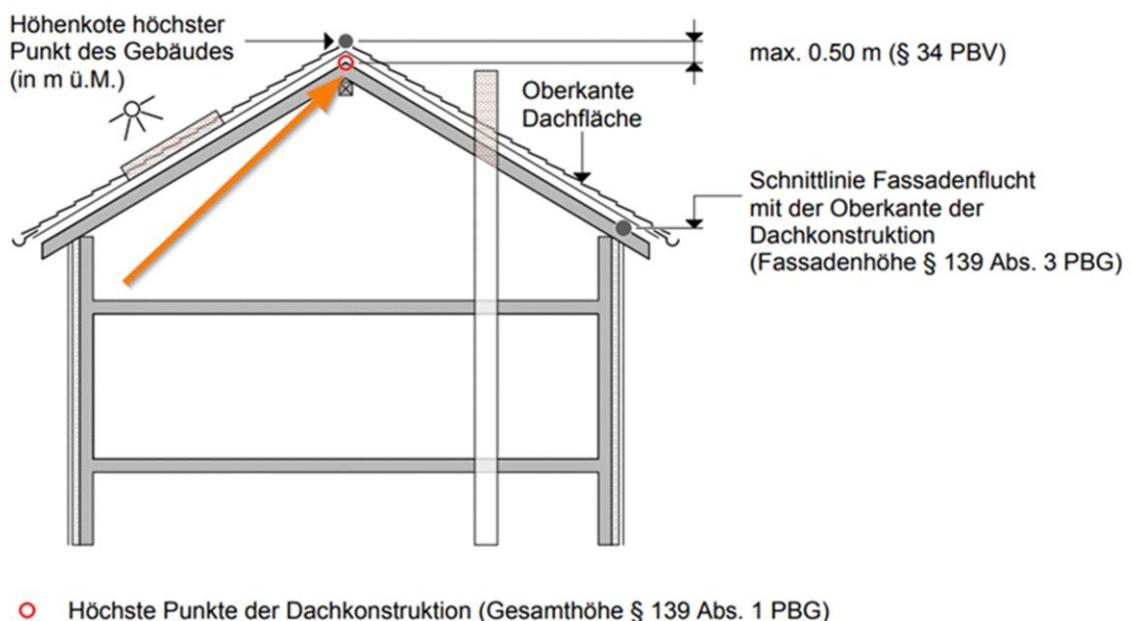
Höchster Punkt der Dachkonstruktion (Skizze BUWD)
